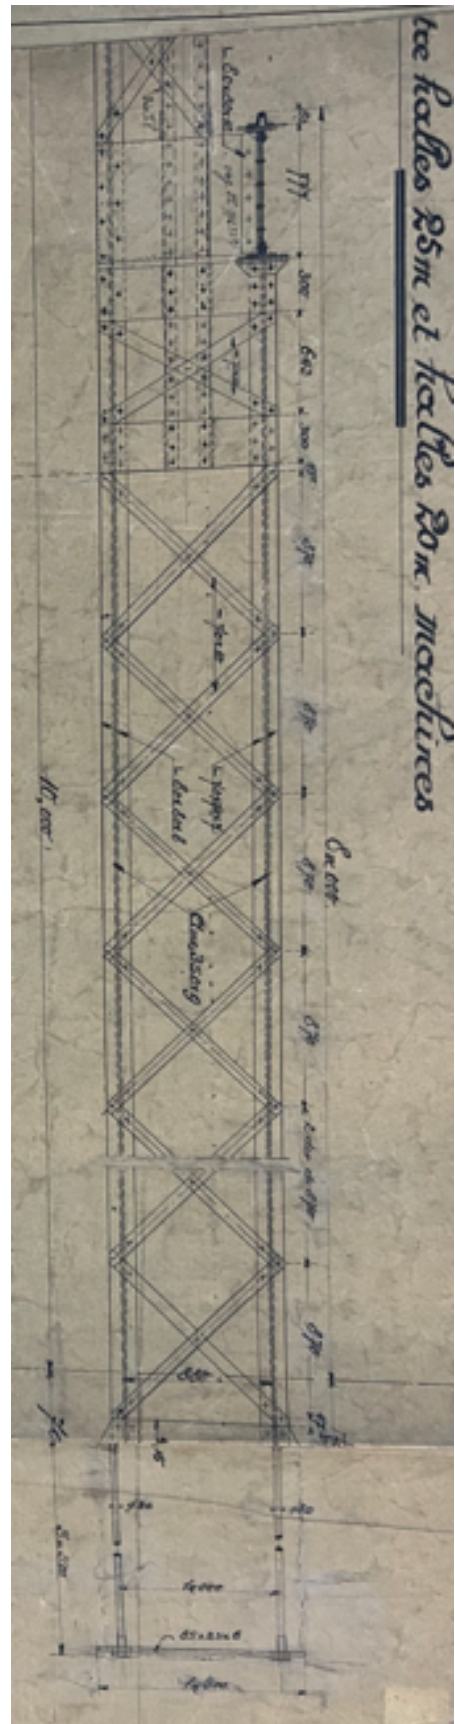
Plans en élévation d'une colonne principale, Exposition de Bruxelles 1910
